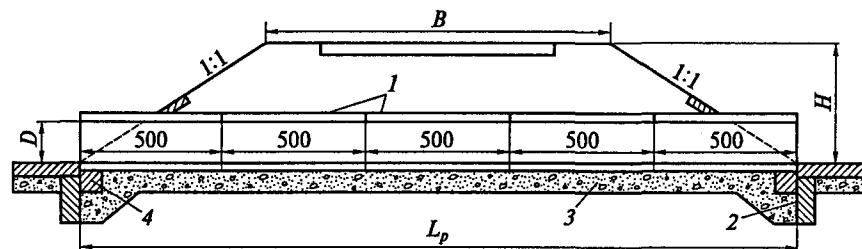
Схема труб из длинномерных звеньев на жестком фундаменте: 1 — длинномерные звенья; 2 — противопольтрационный экран; 3 — щебеночно-песчаная подушка; 4 — оппорный блок из монолитного бетона
